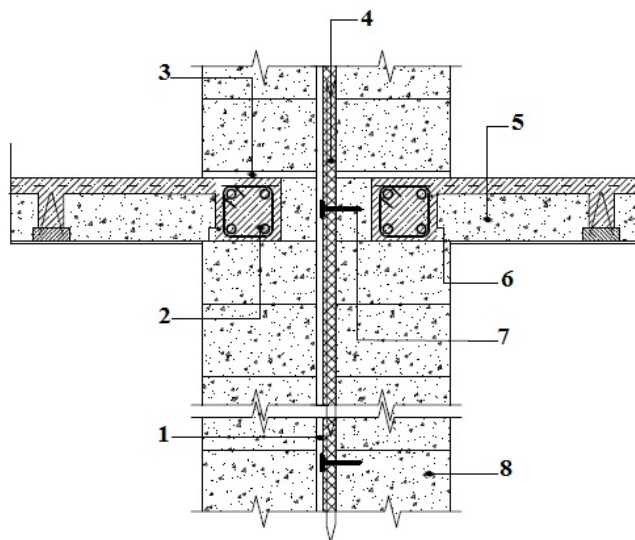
Схема устройства межсекционной несущей стены из газобетонных блоков:
